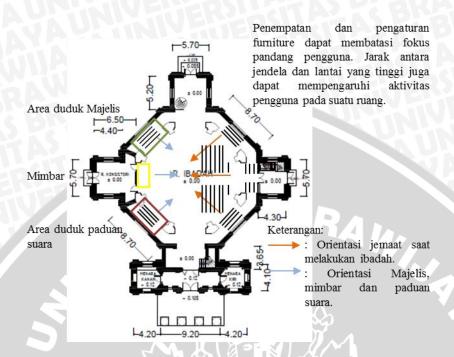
Orientasi ruang pada lantai 1 bangunan Gereja Blenduk berdasarkan bukaan
